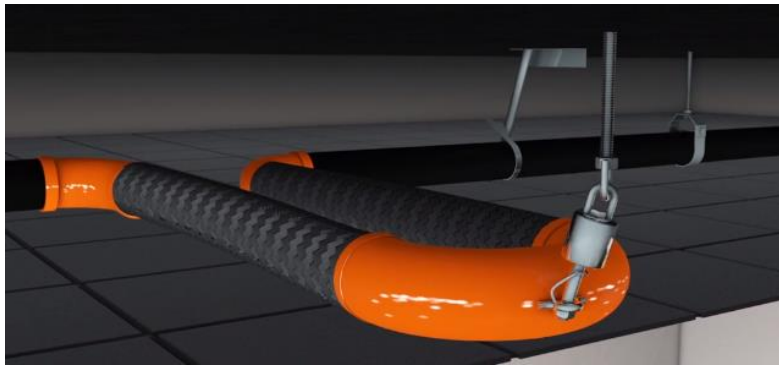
Líneas flexibles de tubería (Fuente: <http://www.metraflex.com>)
